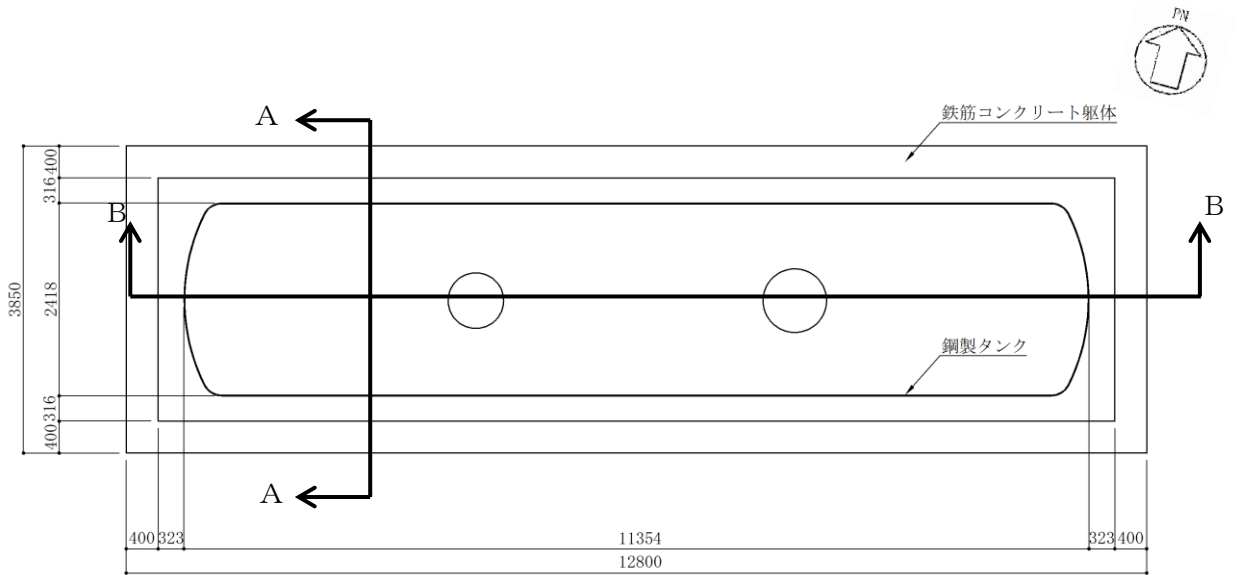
緊急時対策所用燃料地下タンク 平面図 (単位:mm)
